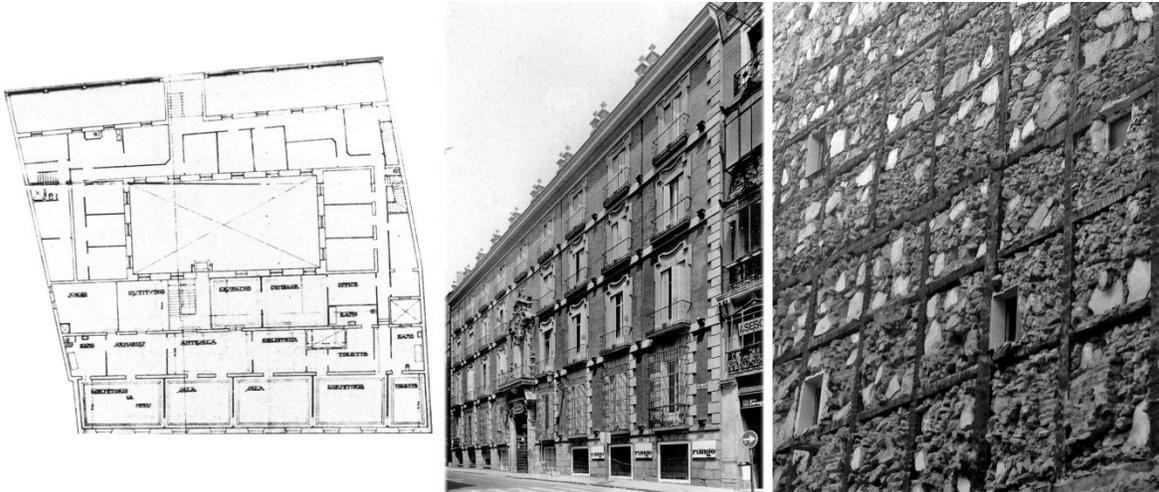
Ejemplo de la arquitectura construida en Madrid en el siglo XVIII, planta y fachada del Palacio de Miraflores, 1731; derecha: detalle de muro a base de entramados de madera con plementería de piedra y ladrillo en sustitución de los muros de carga convencionales.
